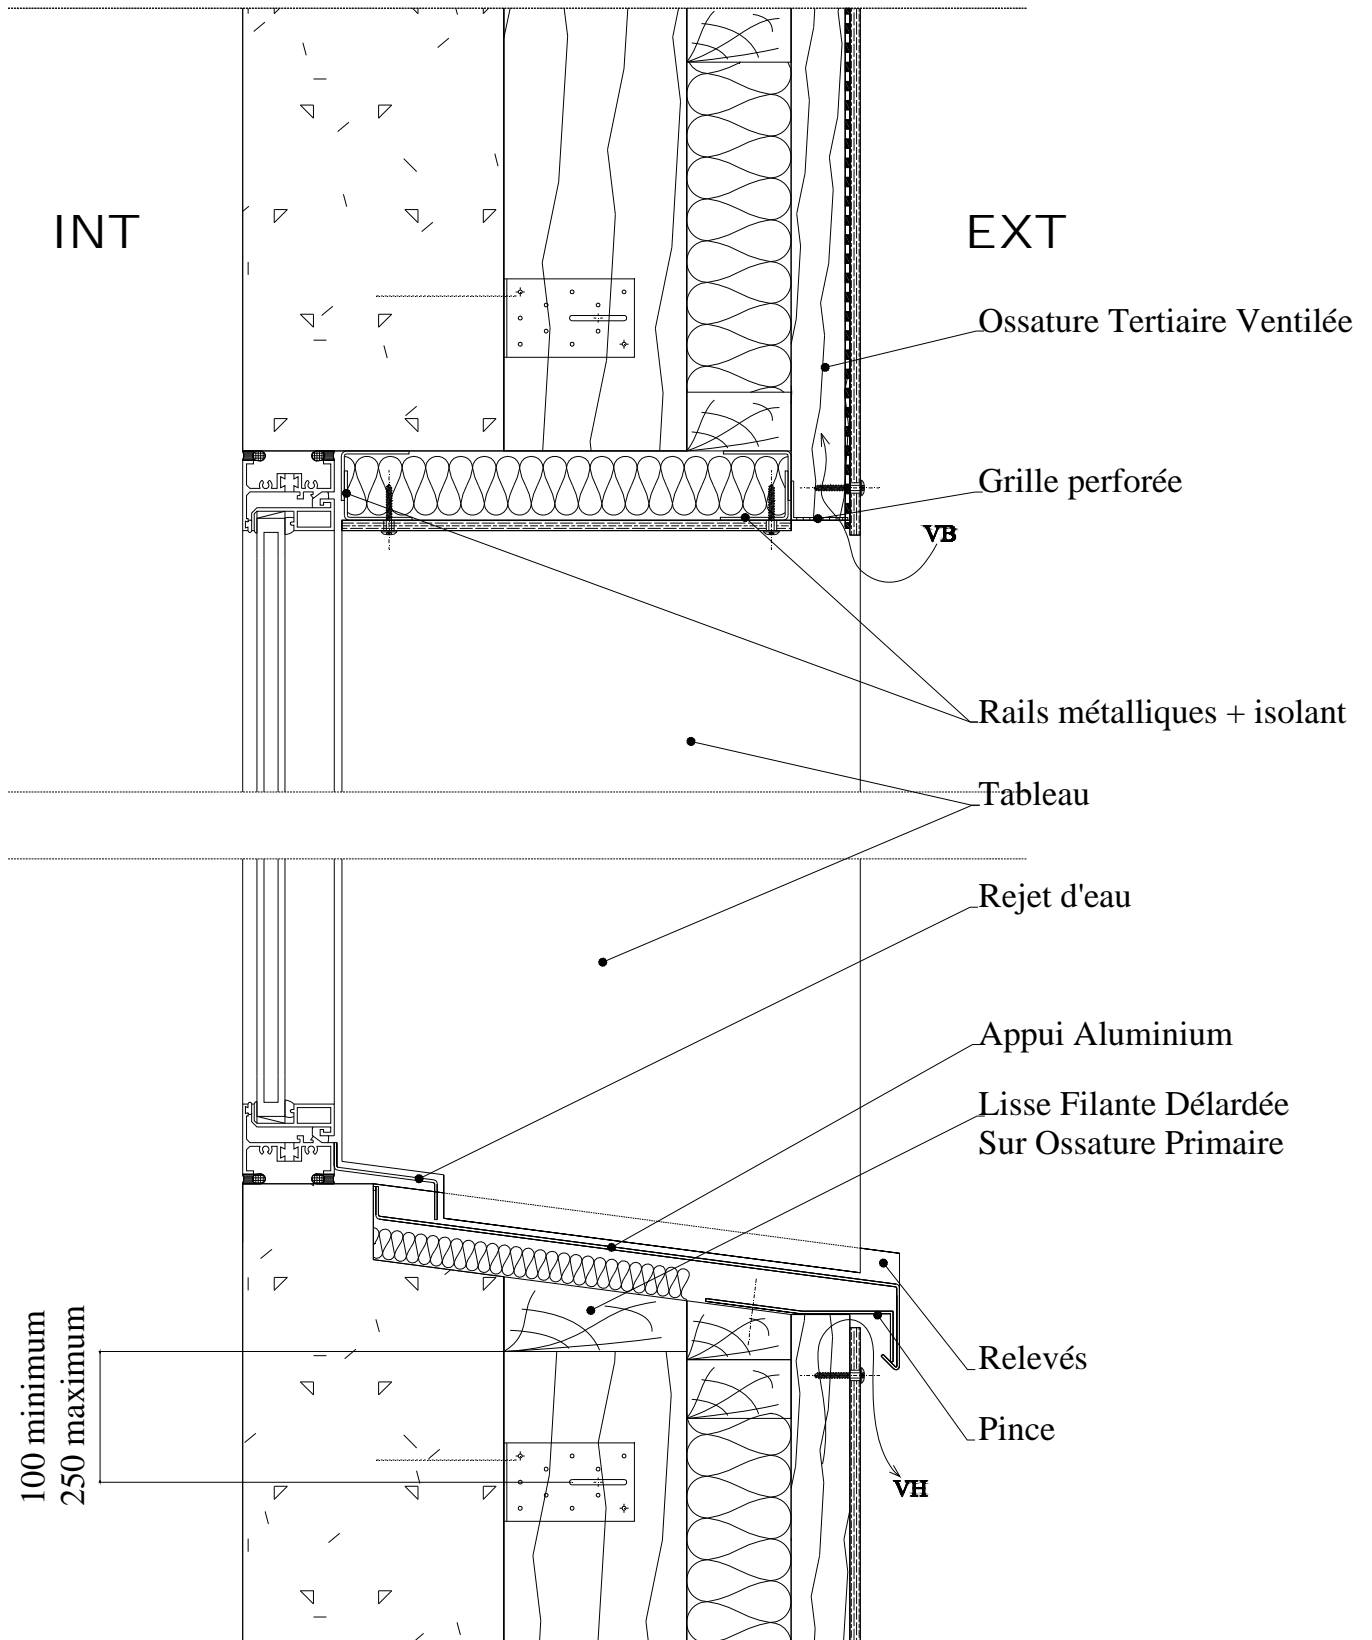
Réseaux croisés sur BA - Coupe verticale sur voussure et appui de menuiserie
